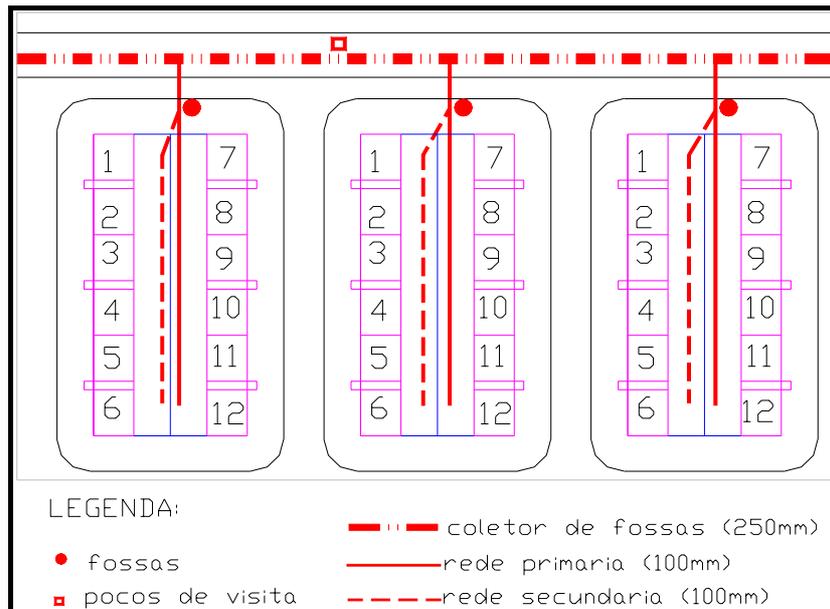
Planta de Localização das Redes de Esgoto Sanitário
